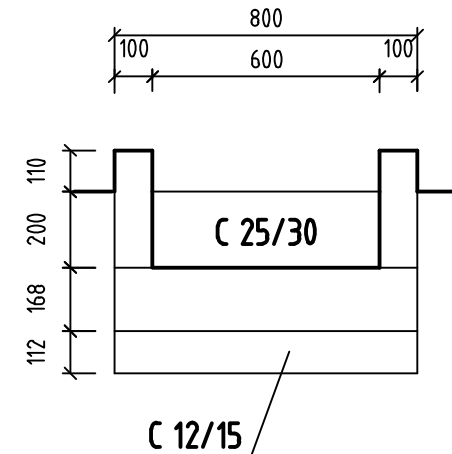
DETAIL TESNENIA PRAČONEJ ŠKÁRY
